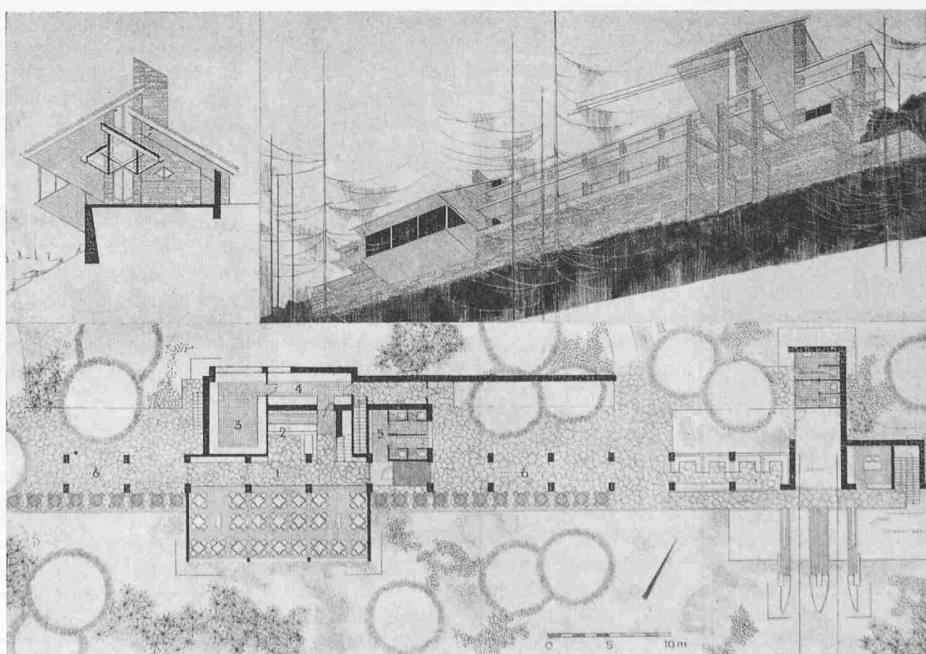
Primo progetto, facciata est del ristorante e pianta 1:600, prospettiva
